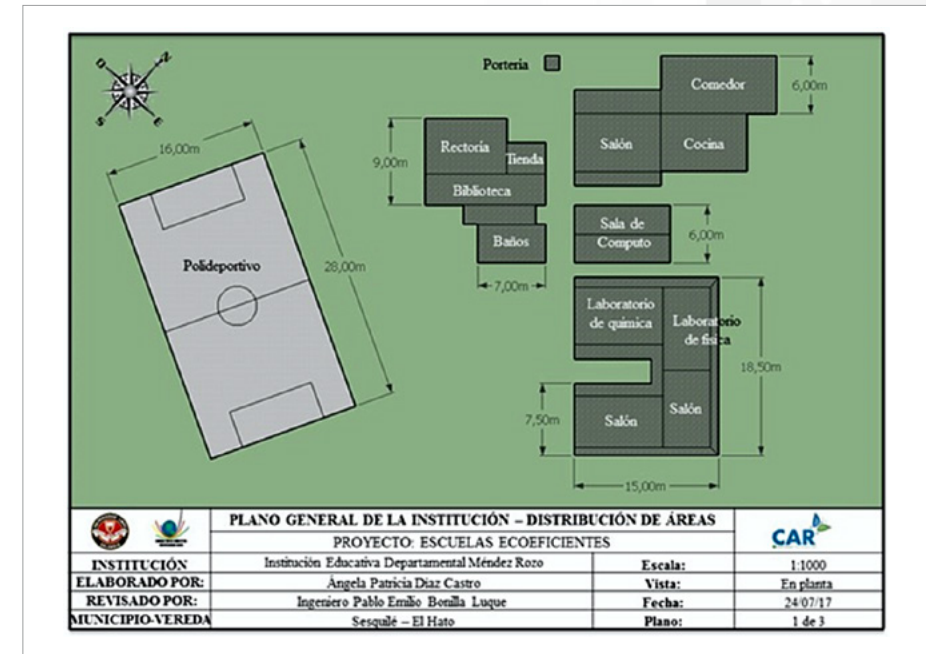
Vista planta Institución Educativa Departamental Méndez Rozo.
